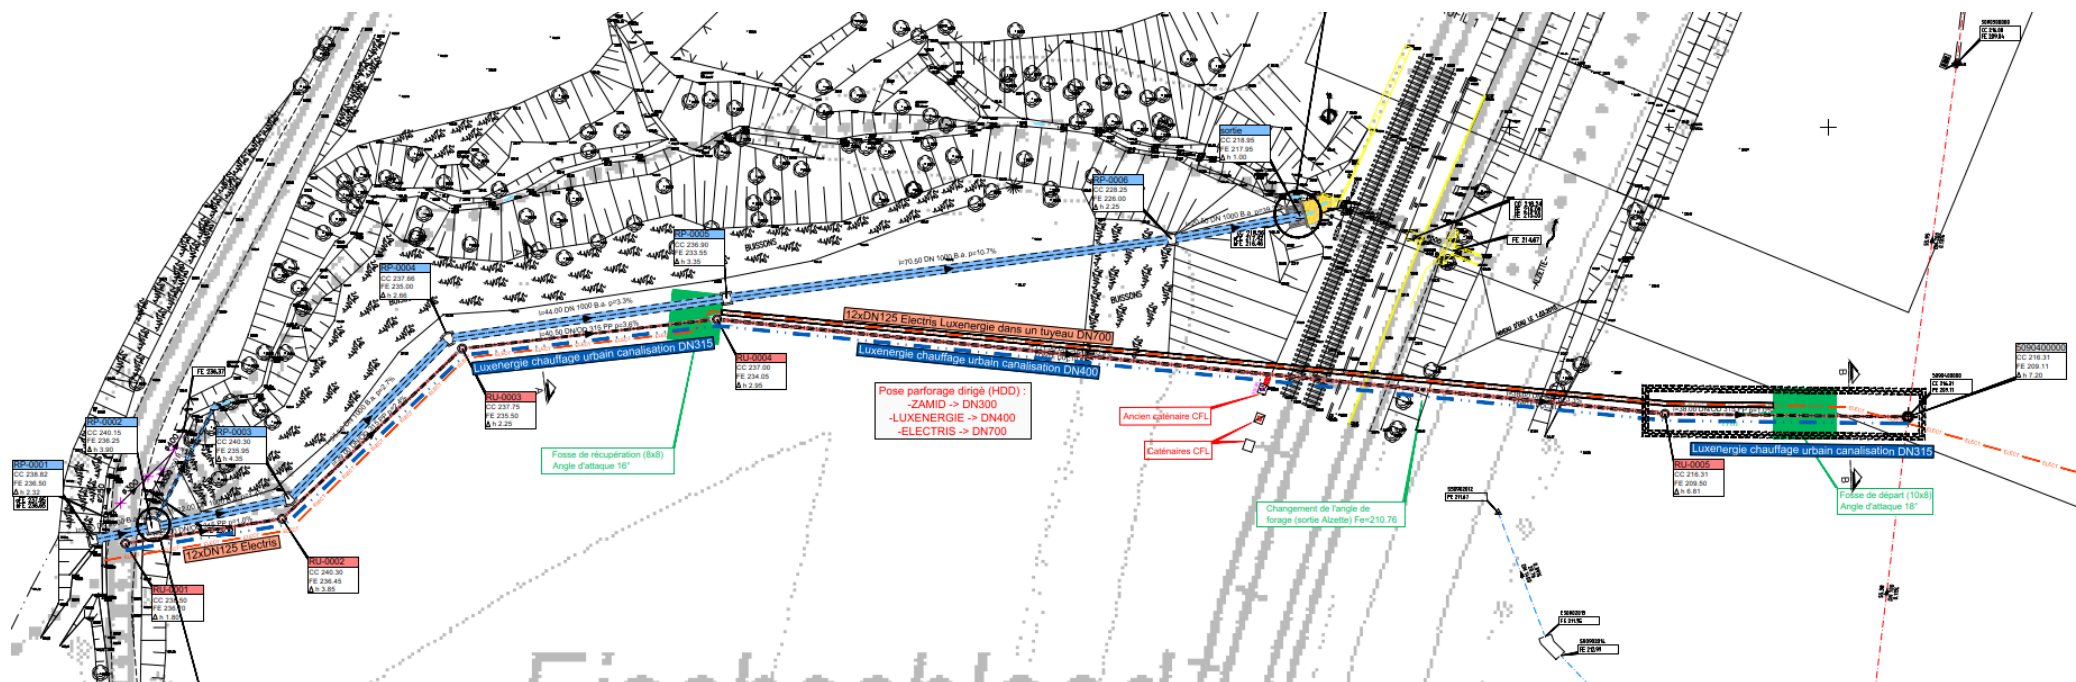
Avant projet du tracé de la conduite et du refoulement dans la canalisation d'eau pluviales (Extrait de plan K P101, Schroeder & Associés, RACCORD CANAL ZAER MERSCHERBERG)
